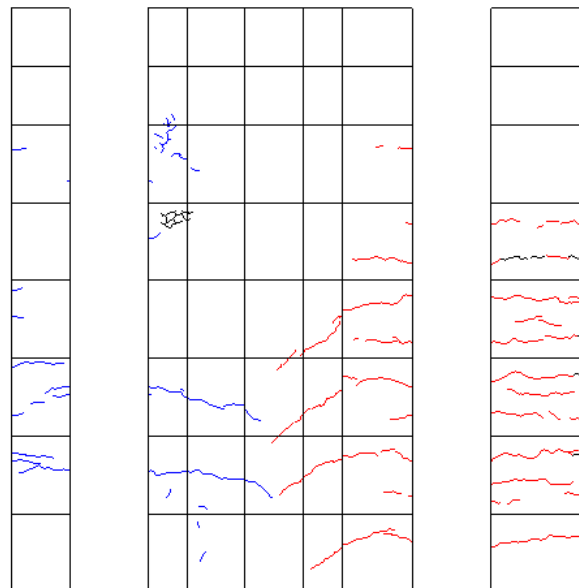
R=1/400②ひび割れ図
